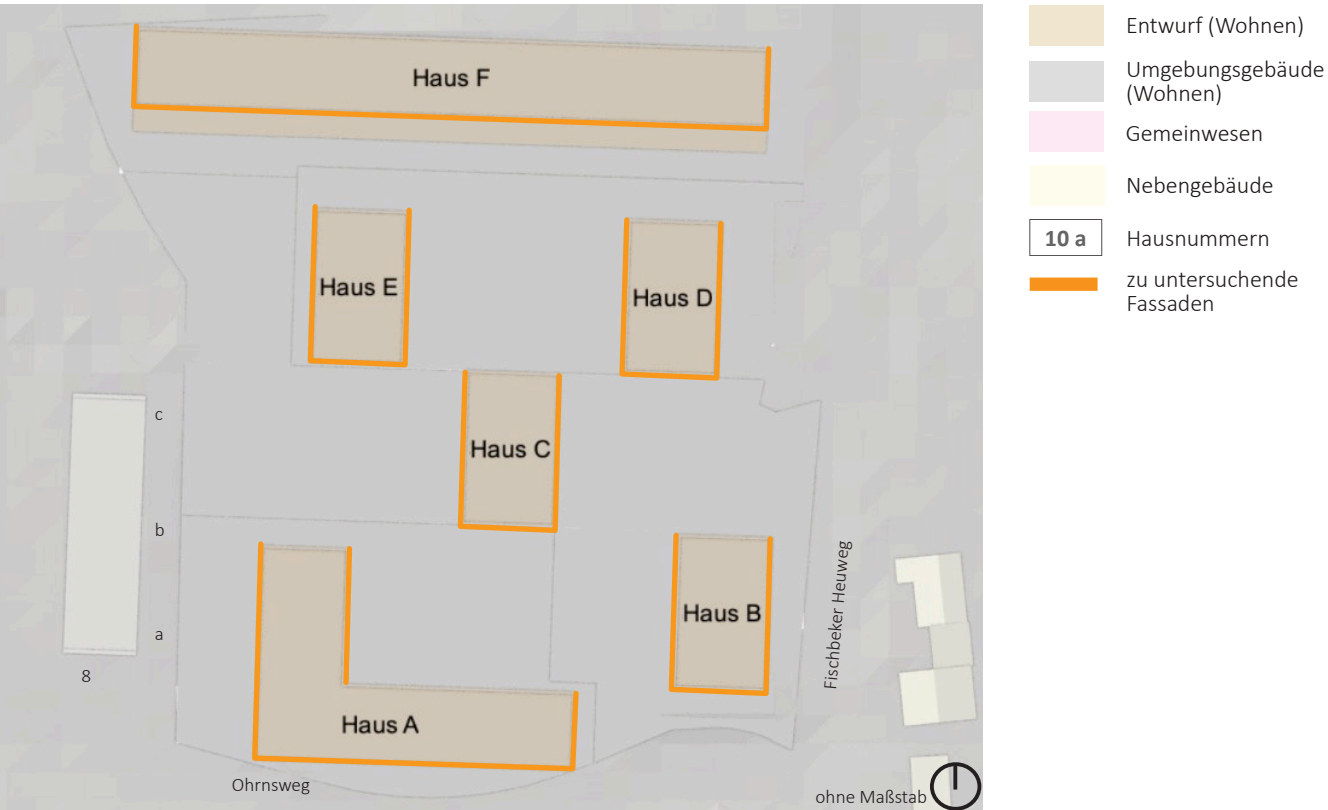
Lageplan mit Gebäudebezeichnung (Entwurf) (Eigene Darstellung.
